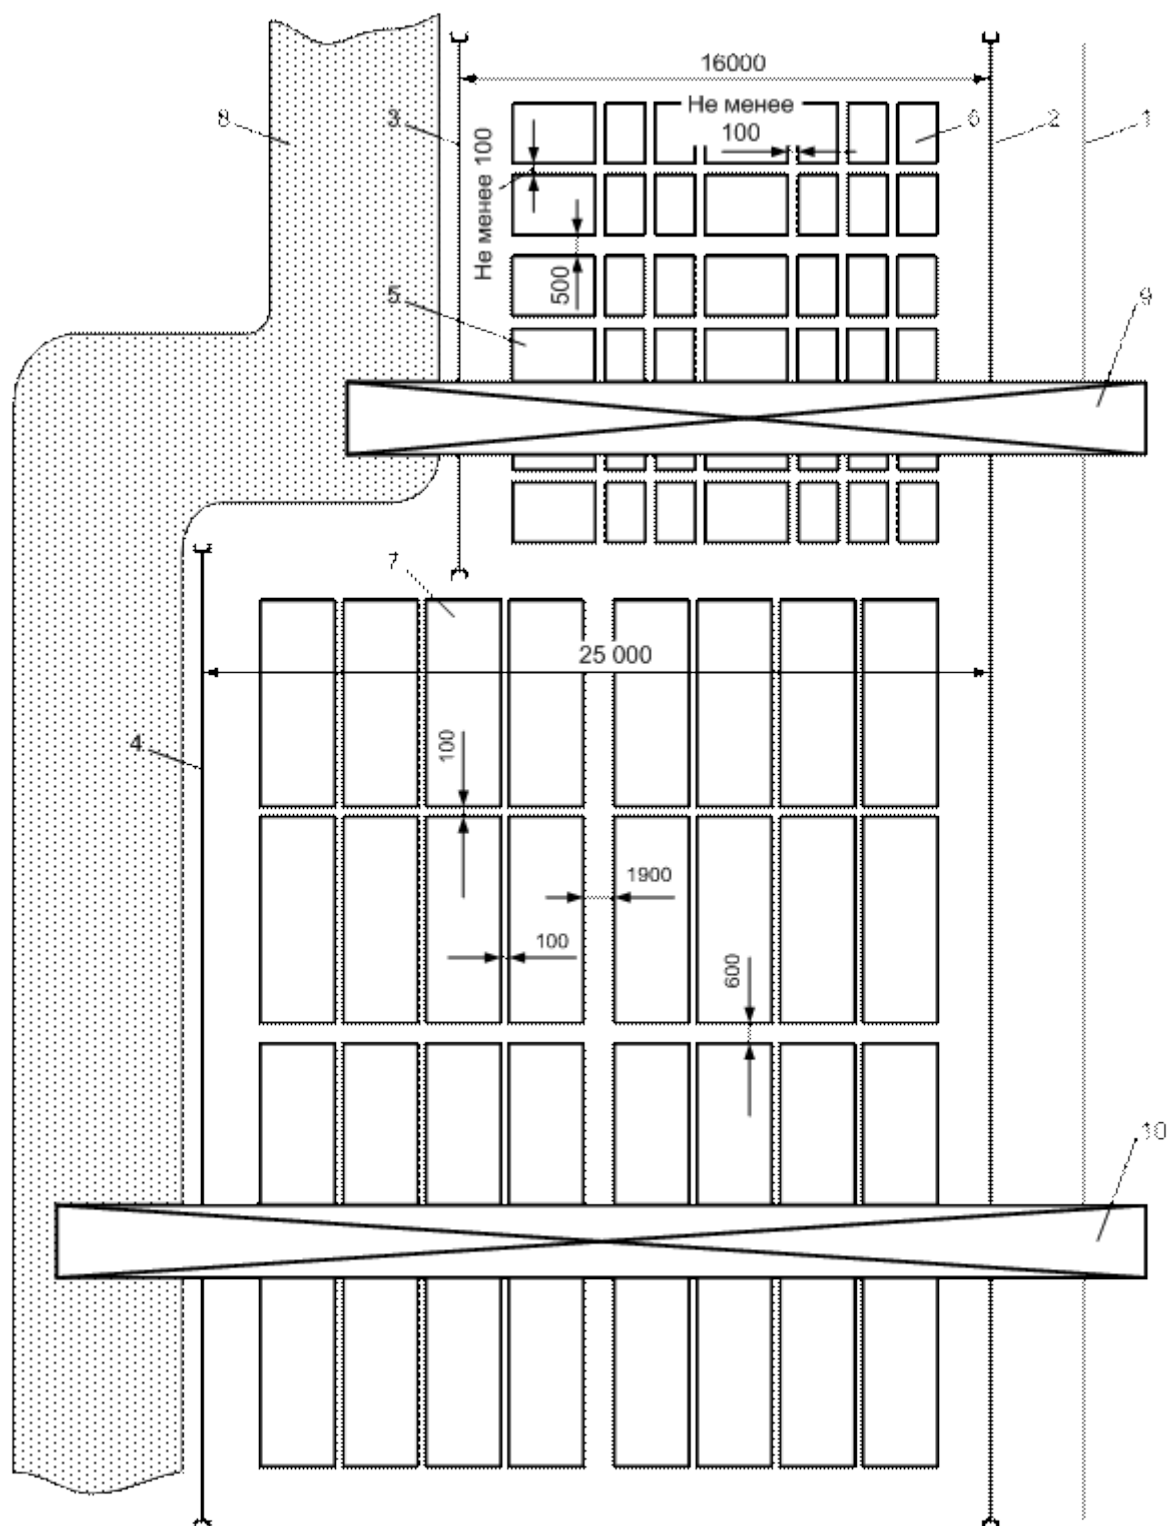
Схема размещения контейнеров на совмещенной площадке для переработки крупнотоннажных и среднетоннажных контейнеров, обслуживаемой козловыми кранами пролетом 16 м и 25 м: 1 – ось железнодорожного пути; 2 – общий подкрановый путь; 3 – подкрановый
